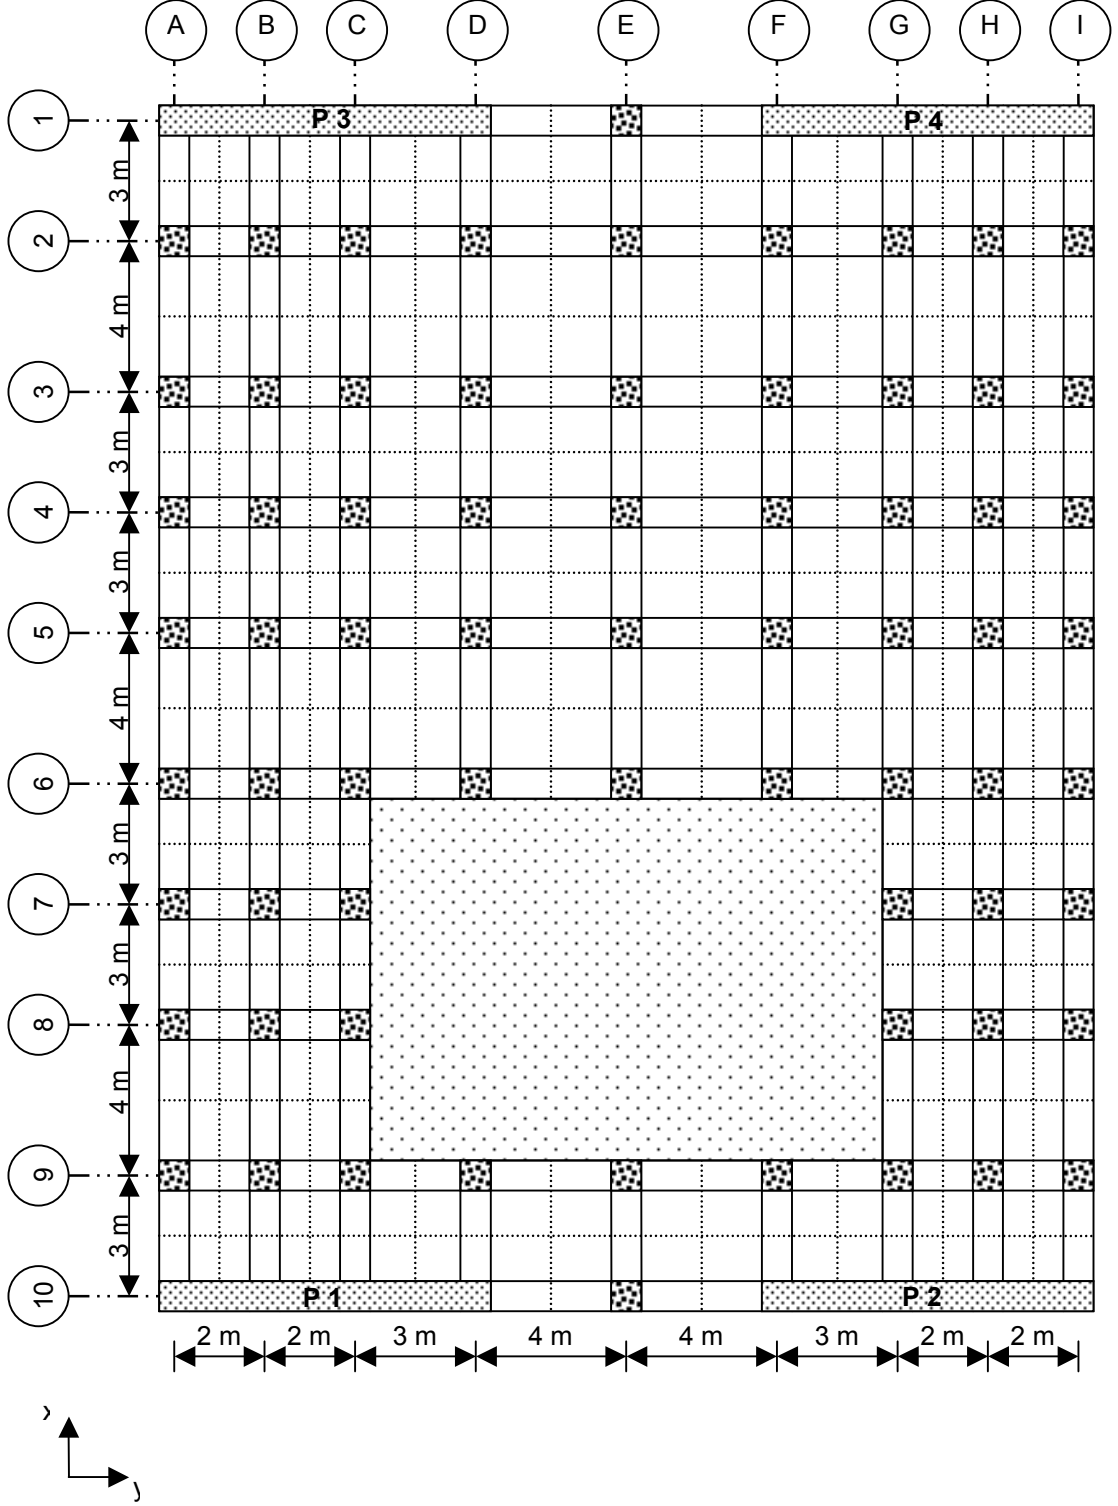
Örnek 5.14'in kat kalıp planı
